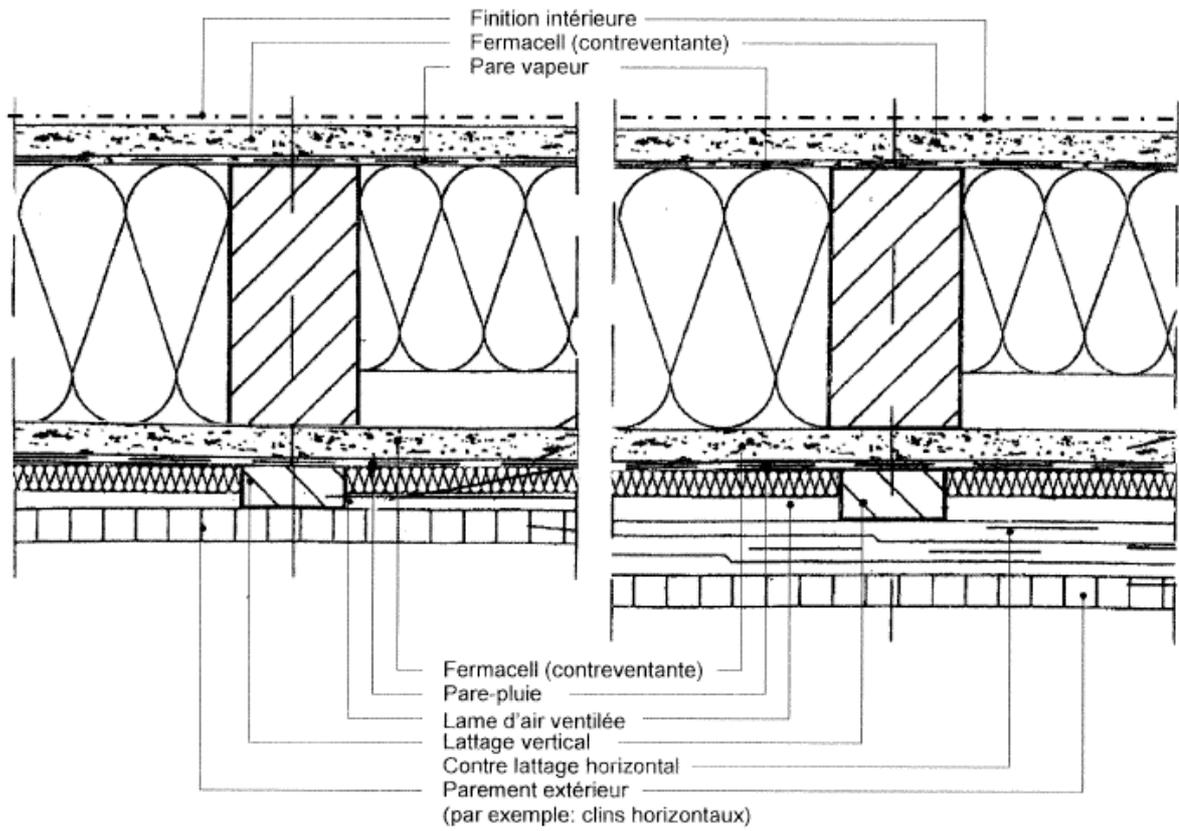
Mur extérieur bardage rapporté – Coupe horizontale
